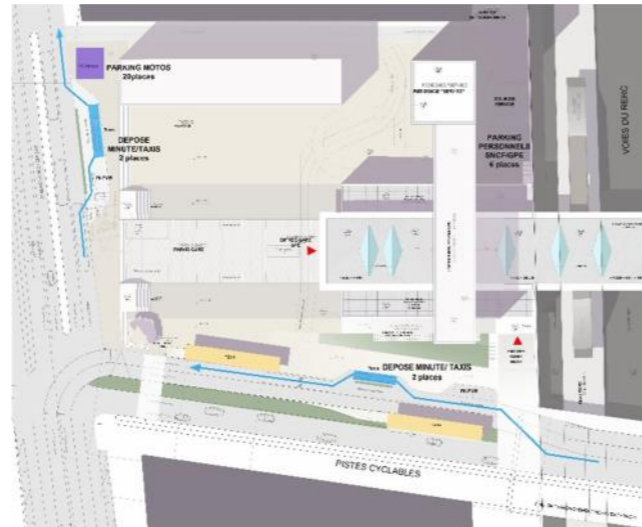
Plan des places de stationnement gare Les Ardoines – VPA (10/11/2014)
